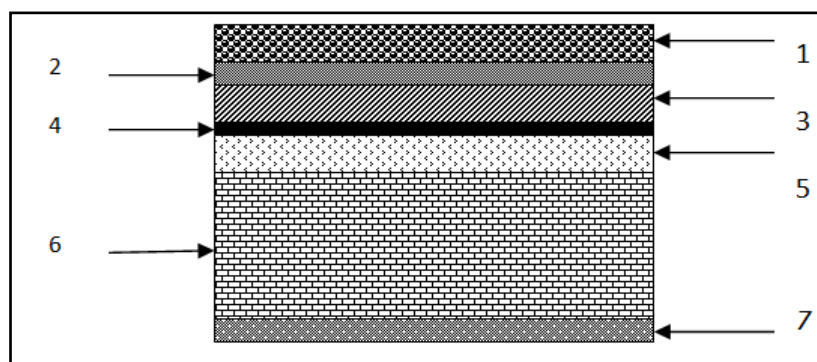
Coupe transversale au niveau de plancher étage terrasse.
